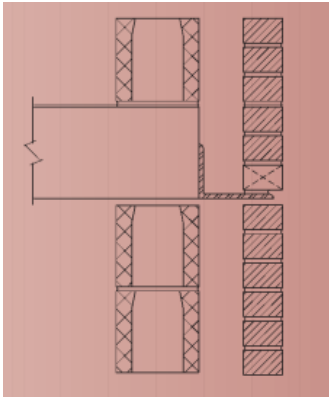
Corte esquemático do apoio do pano exterior em tijolo face à vista em cantoneira. [18]
